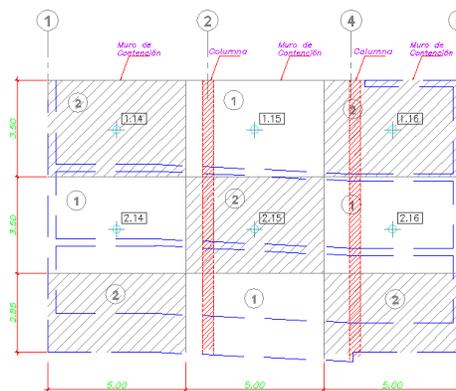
Muro Anclado - Detalle de Modulación en “Eje A”.
